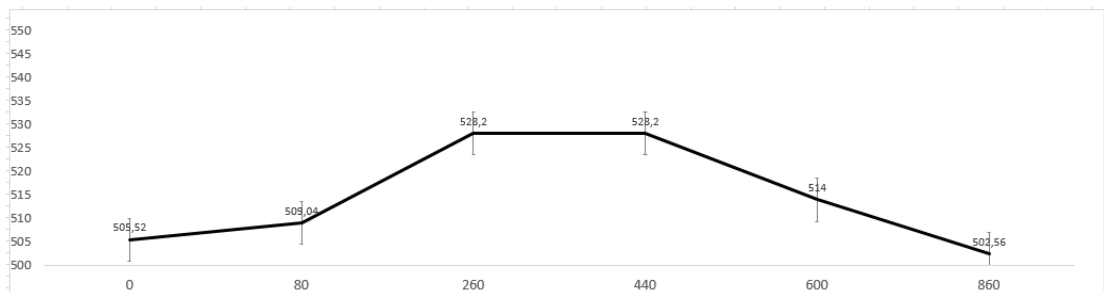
Perfil longitudinal Elevado 1 Guacara – Bárbula
